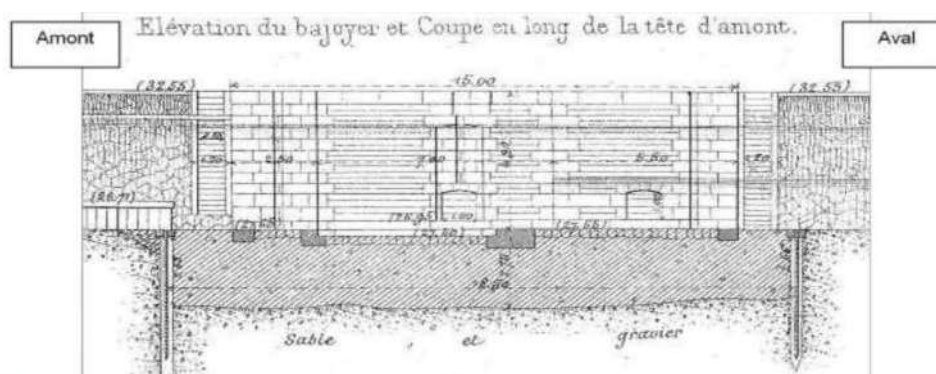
Plan d'archive élévation tête amont d'une écluse de l'itinéraire Seine amont (Archives VNF)
